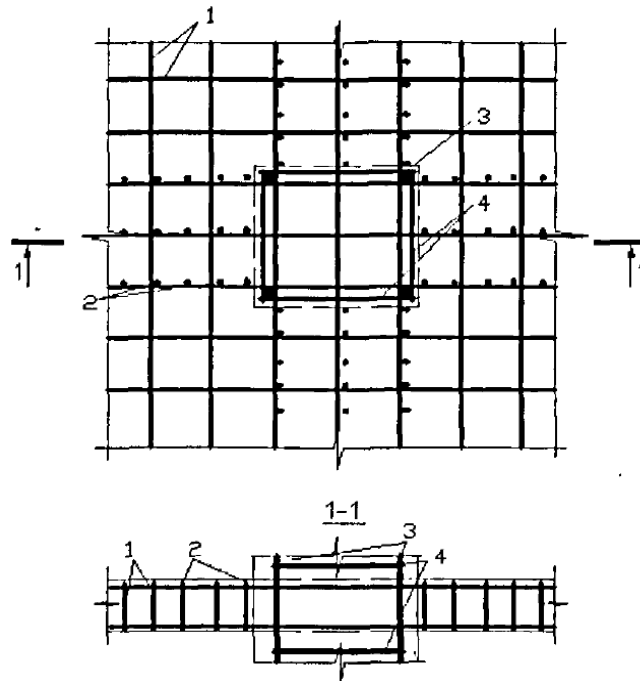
Узел сопряжения безбалочной плиты монолитного перекрытия с колонной без капители
